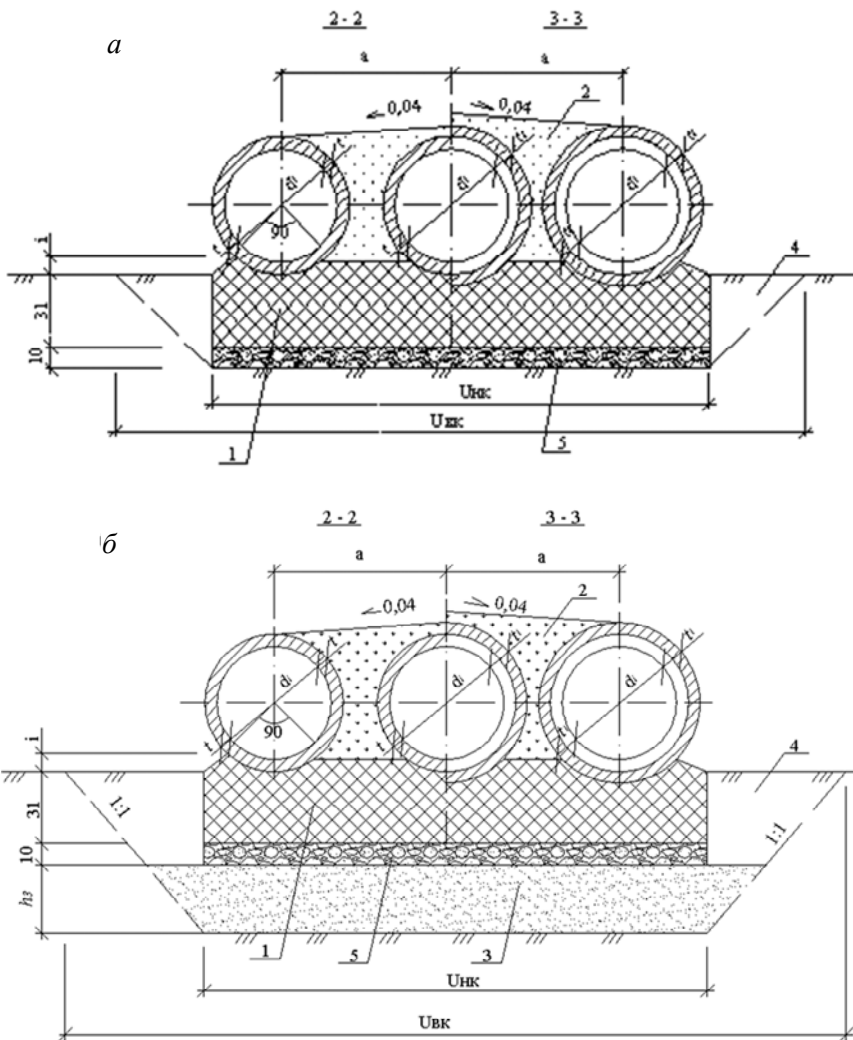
Поперечные разрезы 2-2 и 3-3 (см. рис. 2.9) трехочковых труб на монолитном фундаменте без замены грунта основания (а) или с заменой (б): 1 – бетон В25; 2 – засыпка пазух бетоном В7,5; 3 – замена грунта основания; 4 – обратная засыпка котлована; 5 – щебень толщиной 10 см
